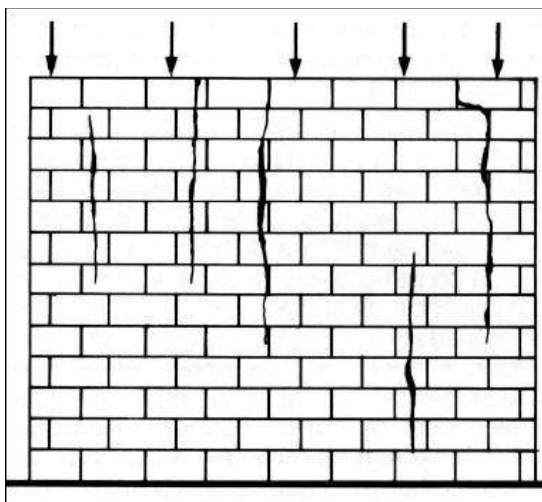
Fissura vertical devido à carga uniformemente distribuída
